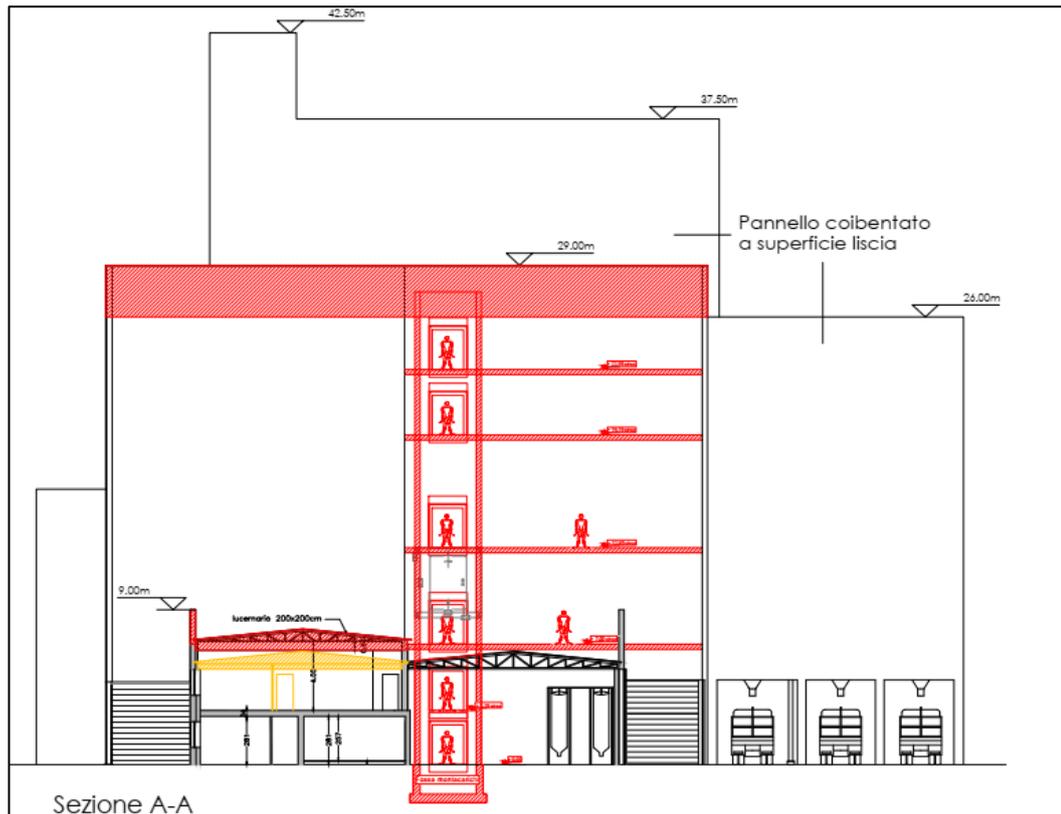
ILLUSTRAZIONE DELL'INSERIMENTO DEL MONTACARICHI E CONSEGUENTE NECESSITÀ DI INNALZAMENTO DELL'ALTEZZA
